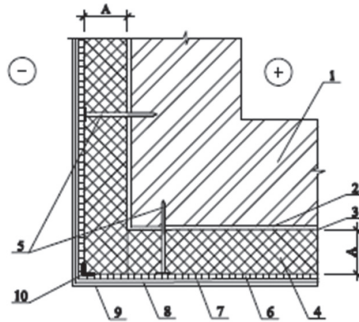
Конструктивна схема влаштування теплоізоляції по зовнішніх кутах будівлі
